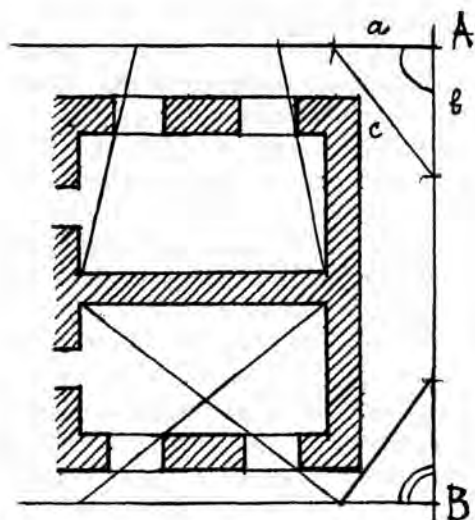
Привязка к сети причалок планов двух смежных помещений, связанных между собою и имеющих проемы, выходящие на разные фасады
